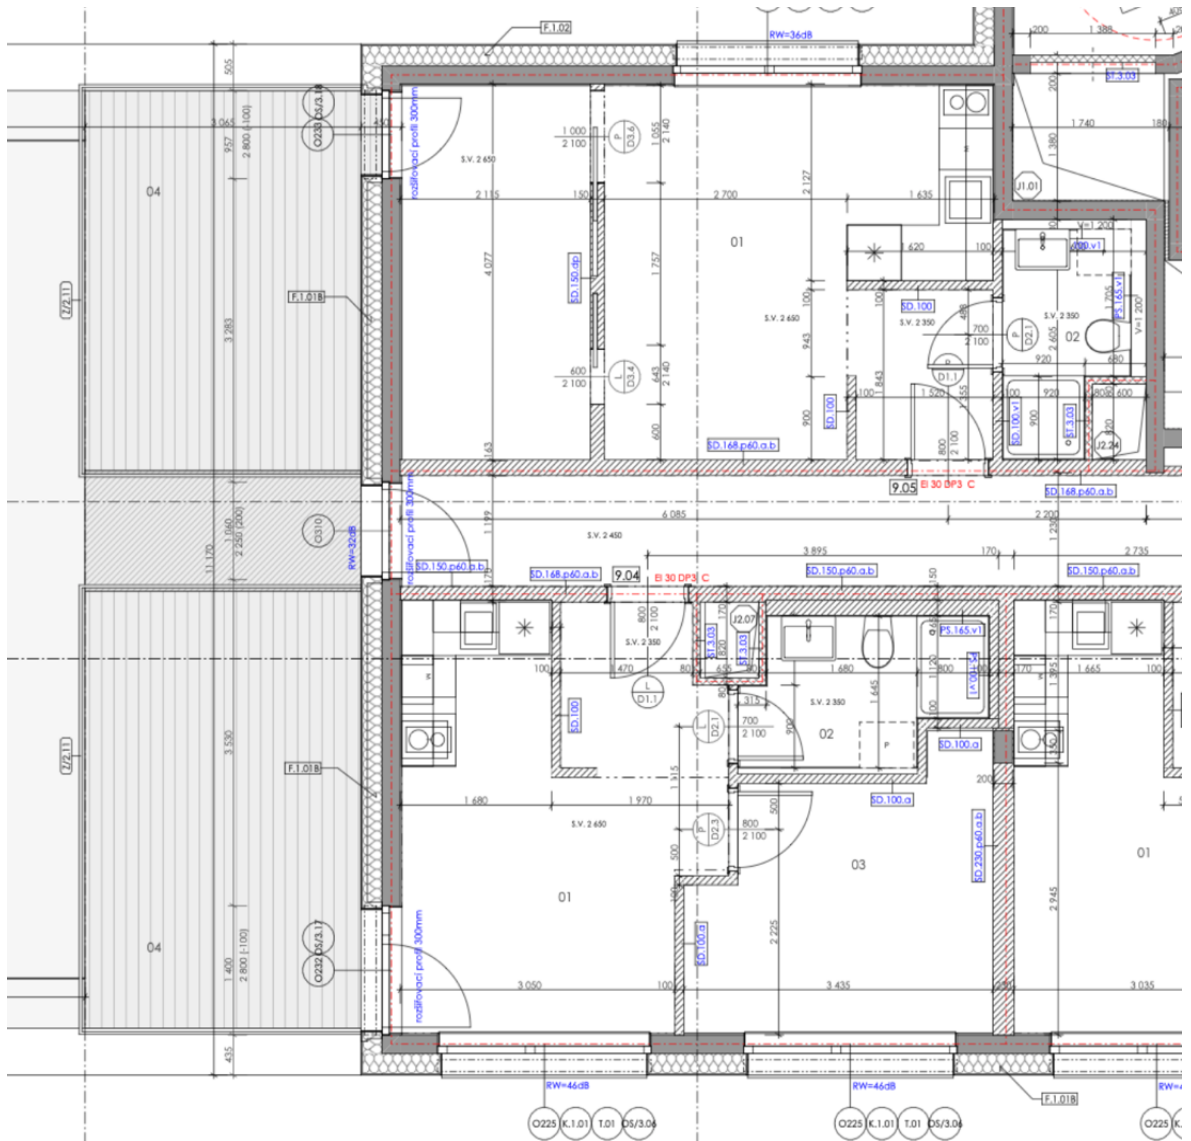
Půdorys typického typu bytové jednotky 1kk (zdroj: projektová dokumentace)
